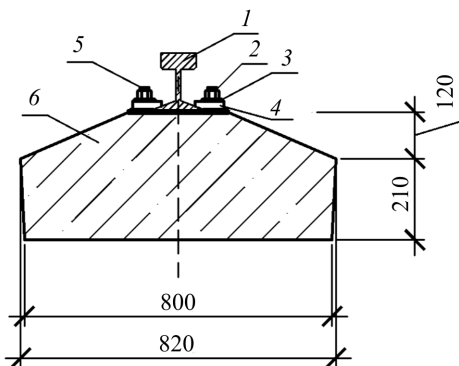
Крепление рельса к балке: 1 – рельс;
